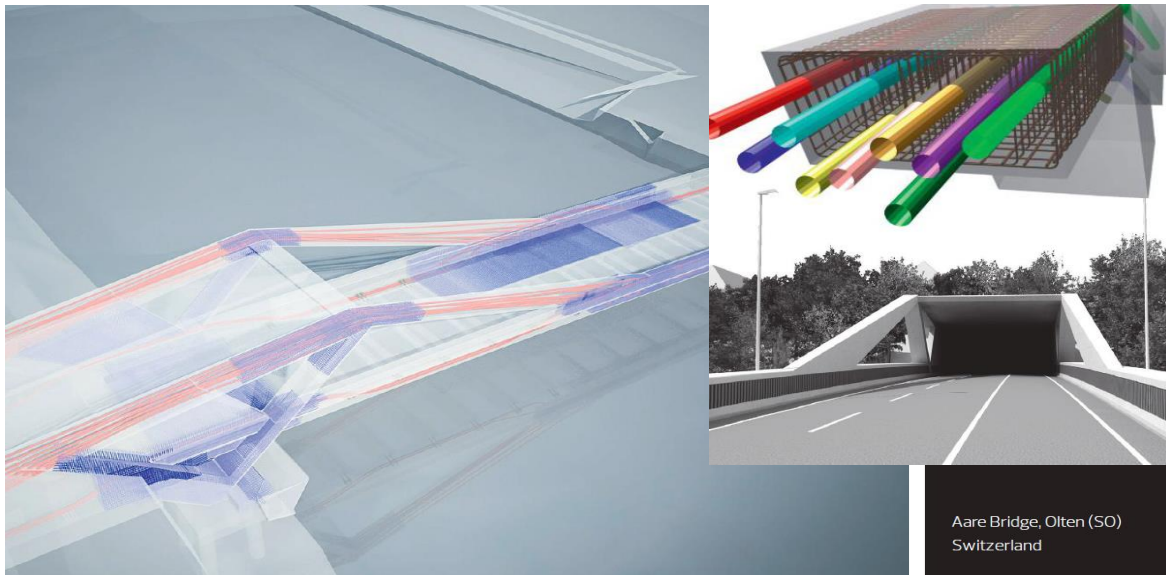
Ejemplo de utilización de All Plan para el diseño de un puente.<sup>41</sup>
